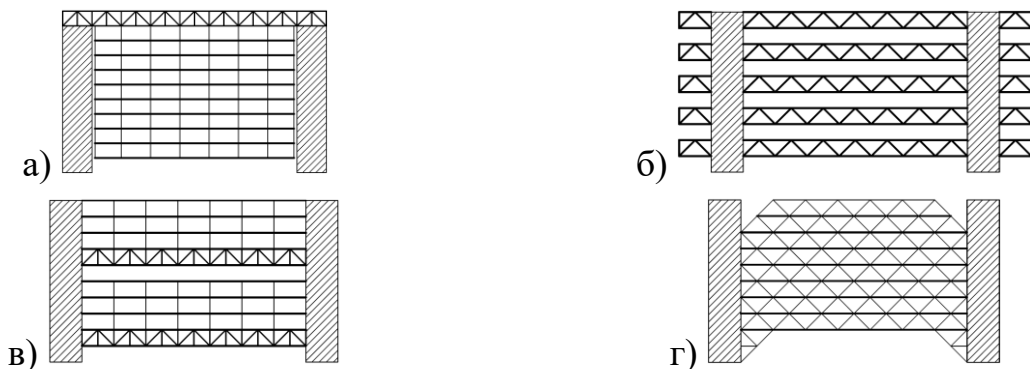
Здания с двумя стволами жёсткости: а) с подвеской перекрытий к фермам; б) с устройством перекрытий по поясам ферм; в) с опиранием перекрытий на фермы; г) с несущим решётчатым каркасом стен
